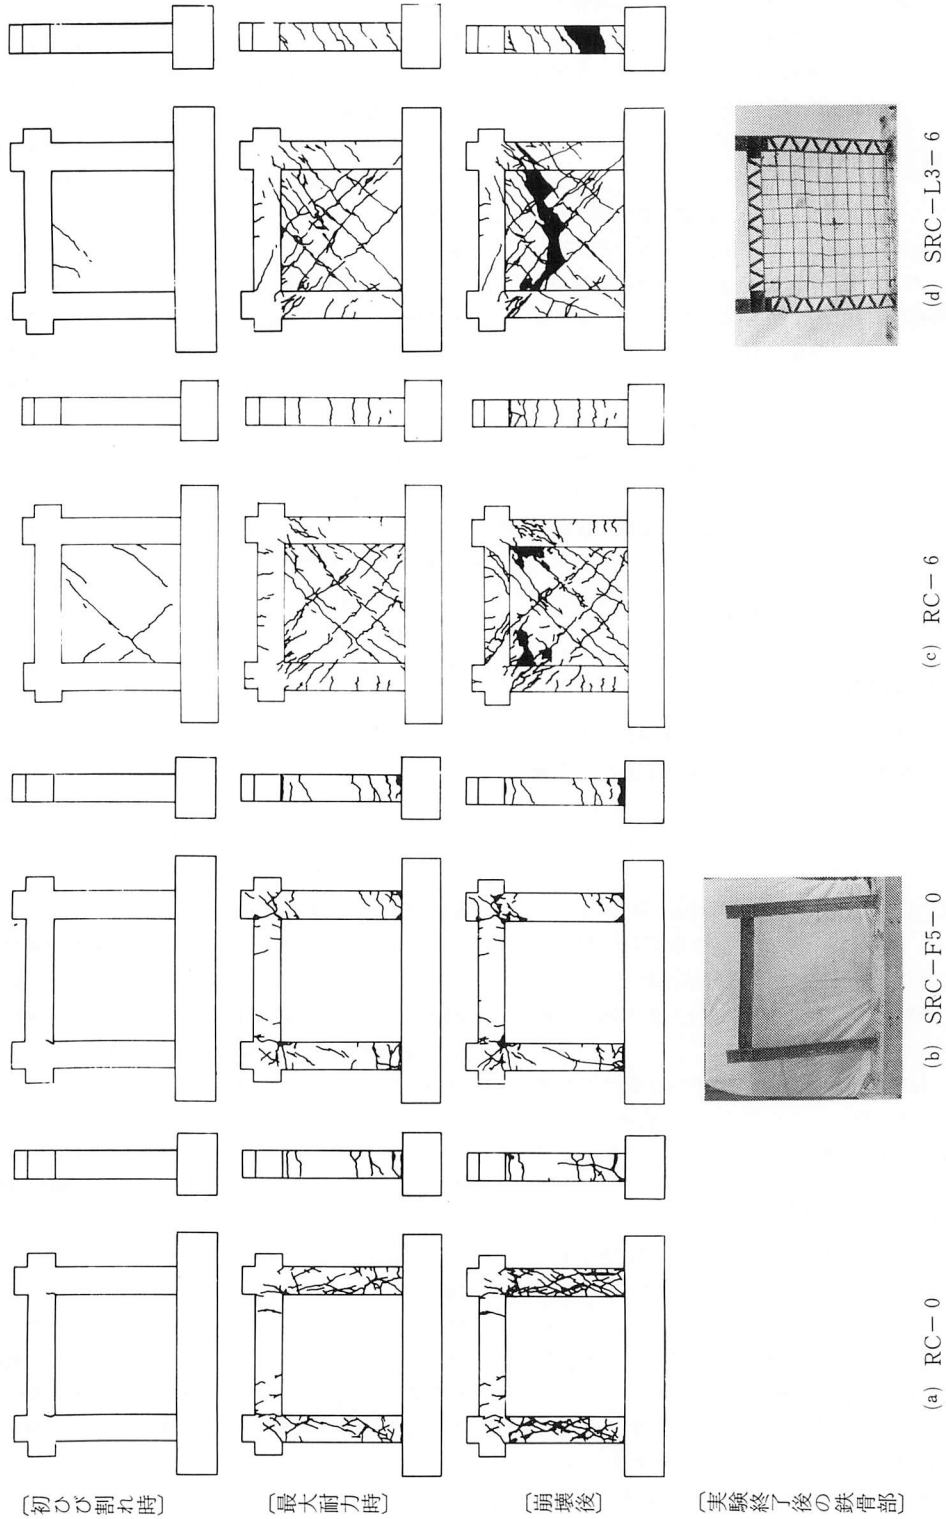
ひび割れ性状, および実験終了後の鉄骨部 (その1)
